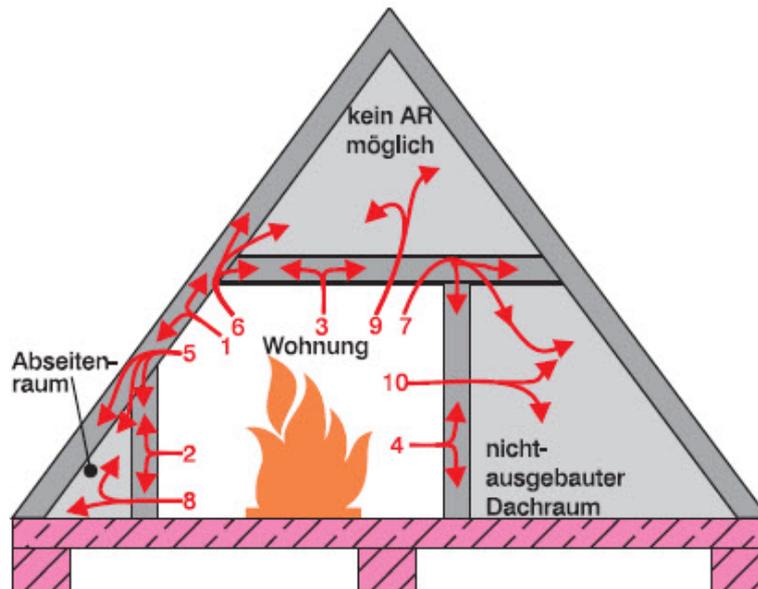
Ausgebautes Dachgeschoß ohne bauliche Brandschutzmaßnahmen. Schwachstellen: Brandausbreitung ist über die Wege 1 bis 10 möglich. [Mayr und Battran /2013/, /15/]
